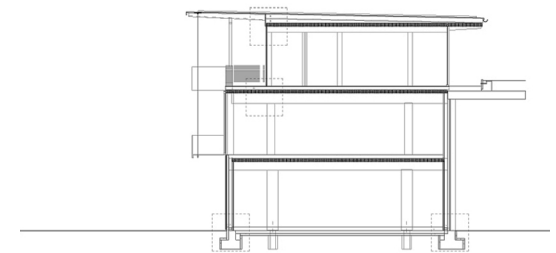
Sezione trasversale; Fonte: www.archinfo.it;
